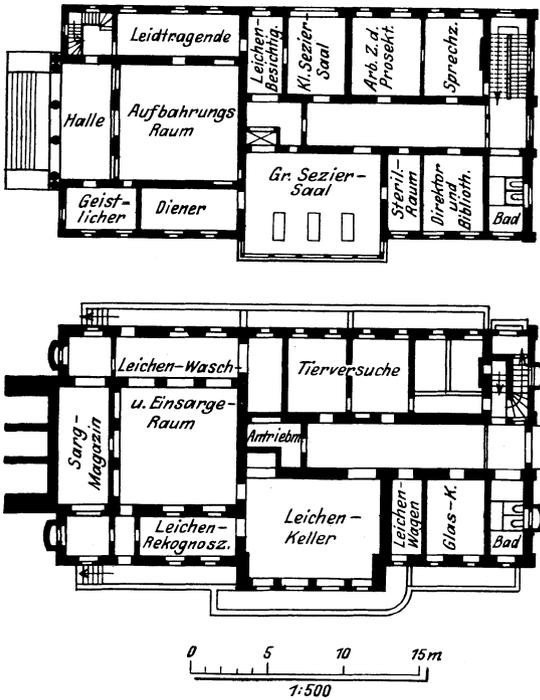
Berlin-Neukölln, städtisches Krankenhaus, Leichenhaus.
